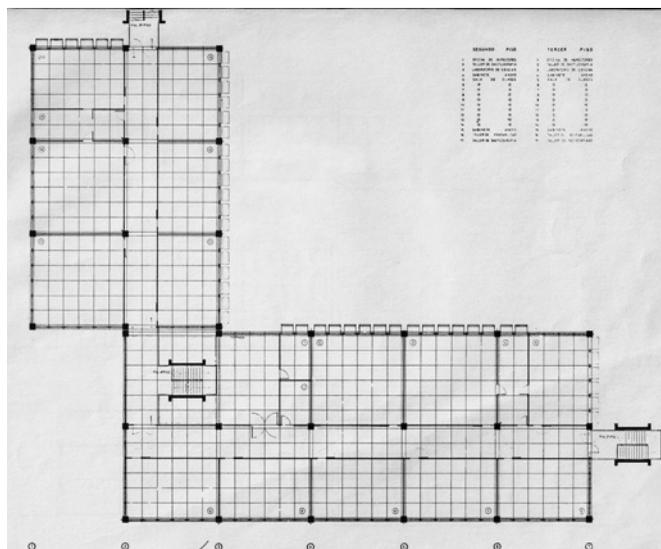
Plano modulación del proyecto Tipo 520. Instituto Superior de Comercio, Viña del Mar. Fuente: SCEE (1975: 52).
